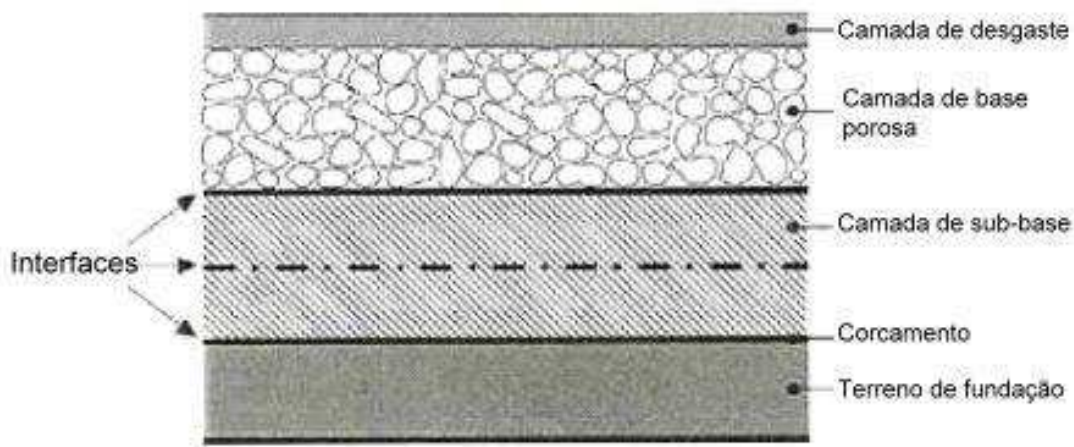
Secção transversal de pavimento “com estrutura de reservatório” (Vale, 2011).
